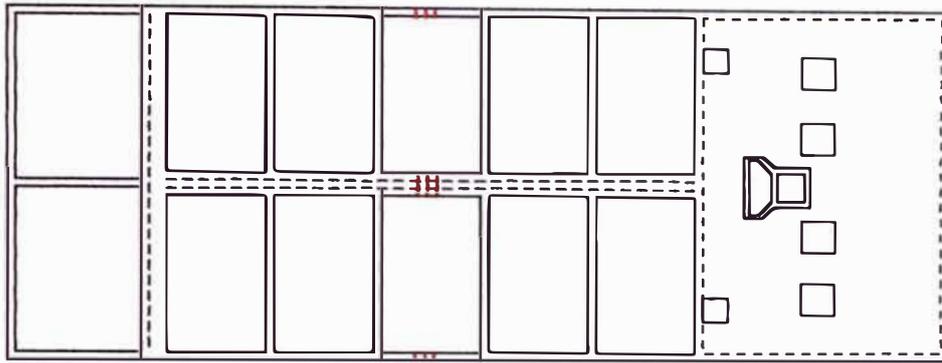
En rojo las fisuras leves en la parte superior de la tercera fila de tanques de aeración.
